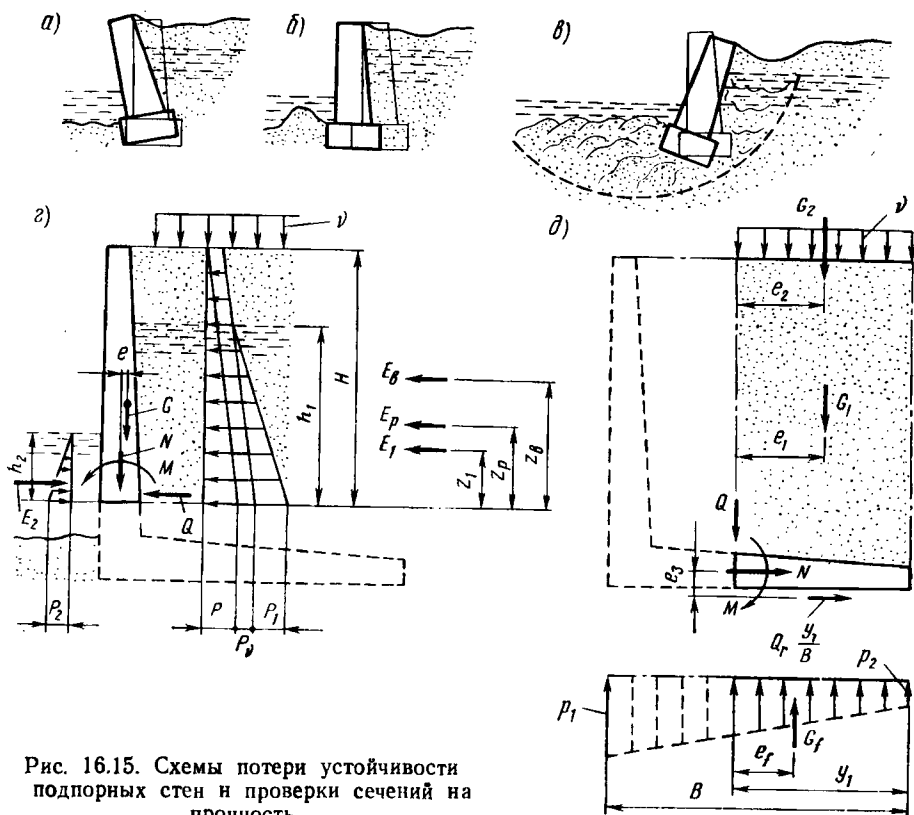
Схемы потери устойчивости подпорных стен и проверки сечений на прочность
